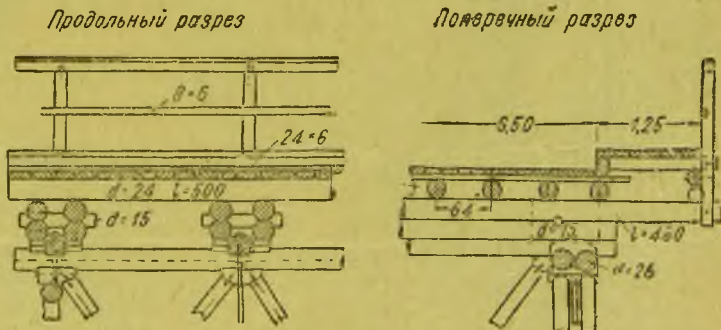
Проезжая часть с непосредственной укладкой поперечин на верхний пояс главных ферм.
